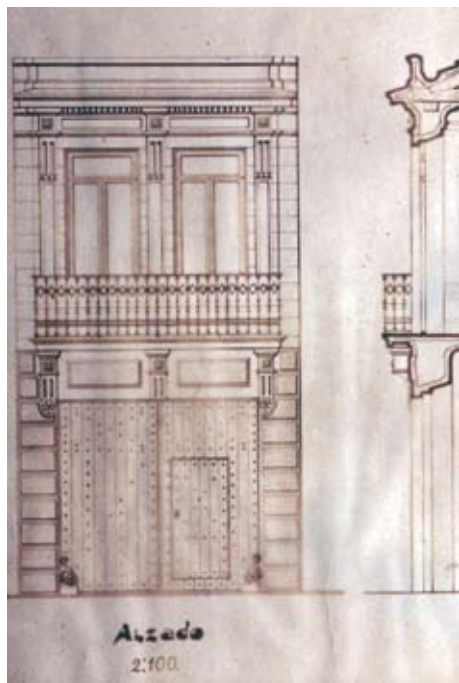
Alzado y sección Callejón de las Portadas, 1924.
